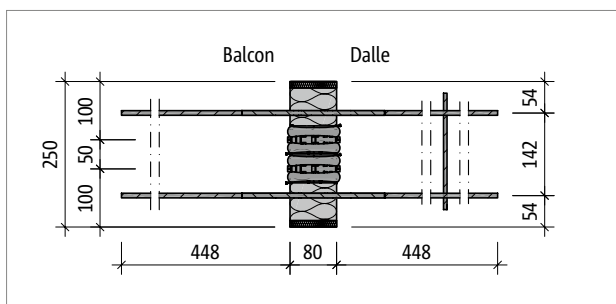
Schöck Isokorb® T type Q-E-V4-L250 : plan de base du produit
